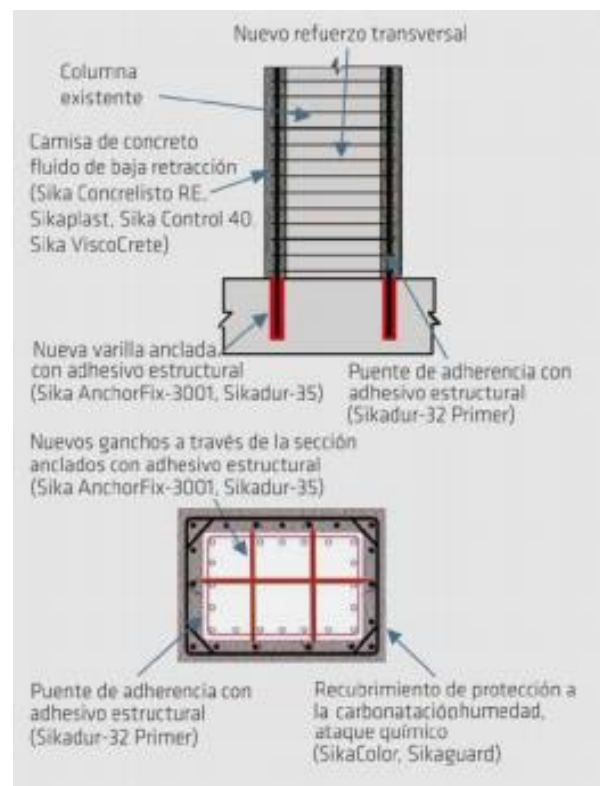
Encamisado en concreto reforzado de una columna. Fuente. SIKA-construyendo confianza
